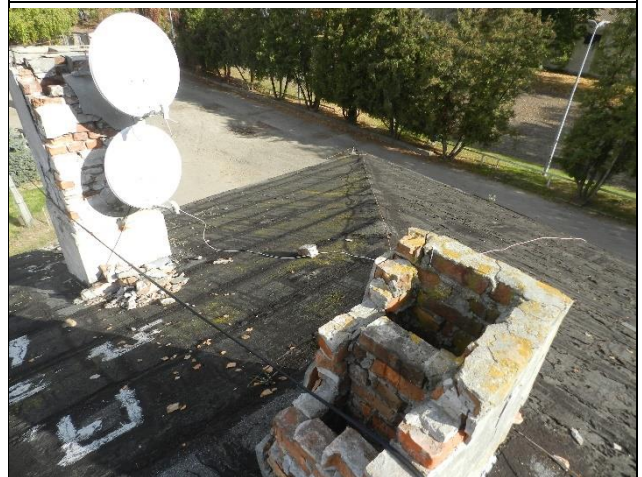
Widok pokrycia dachowego na połaci wschodniej.
